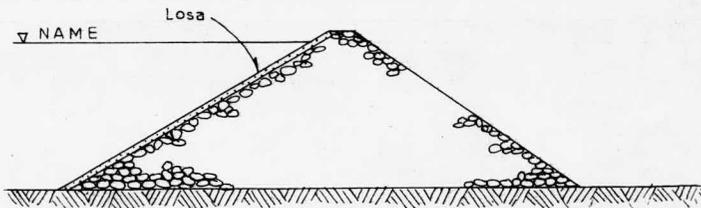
Sección de cortina de enrocamiento con losa de concreto o asfalto.
